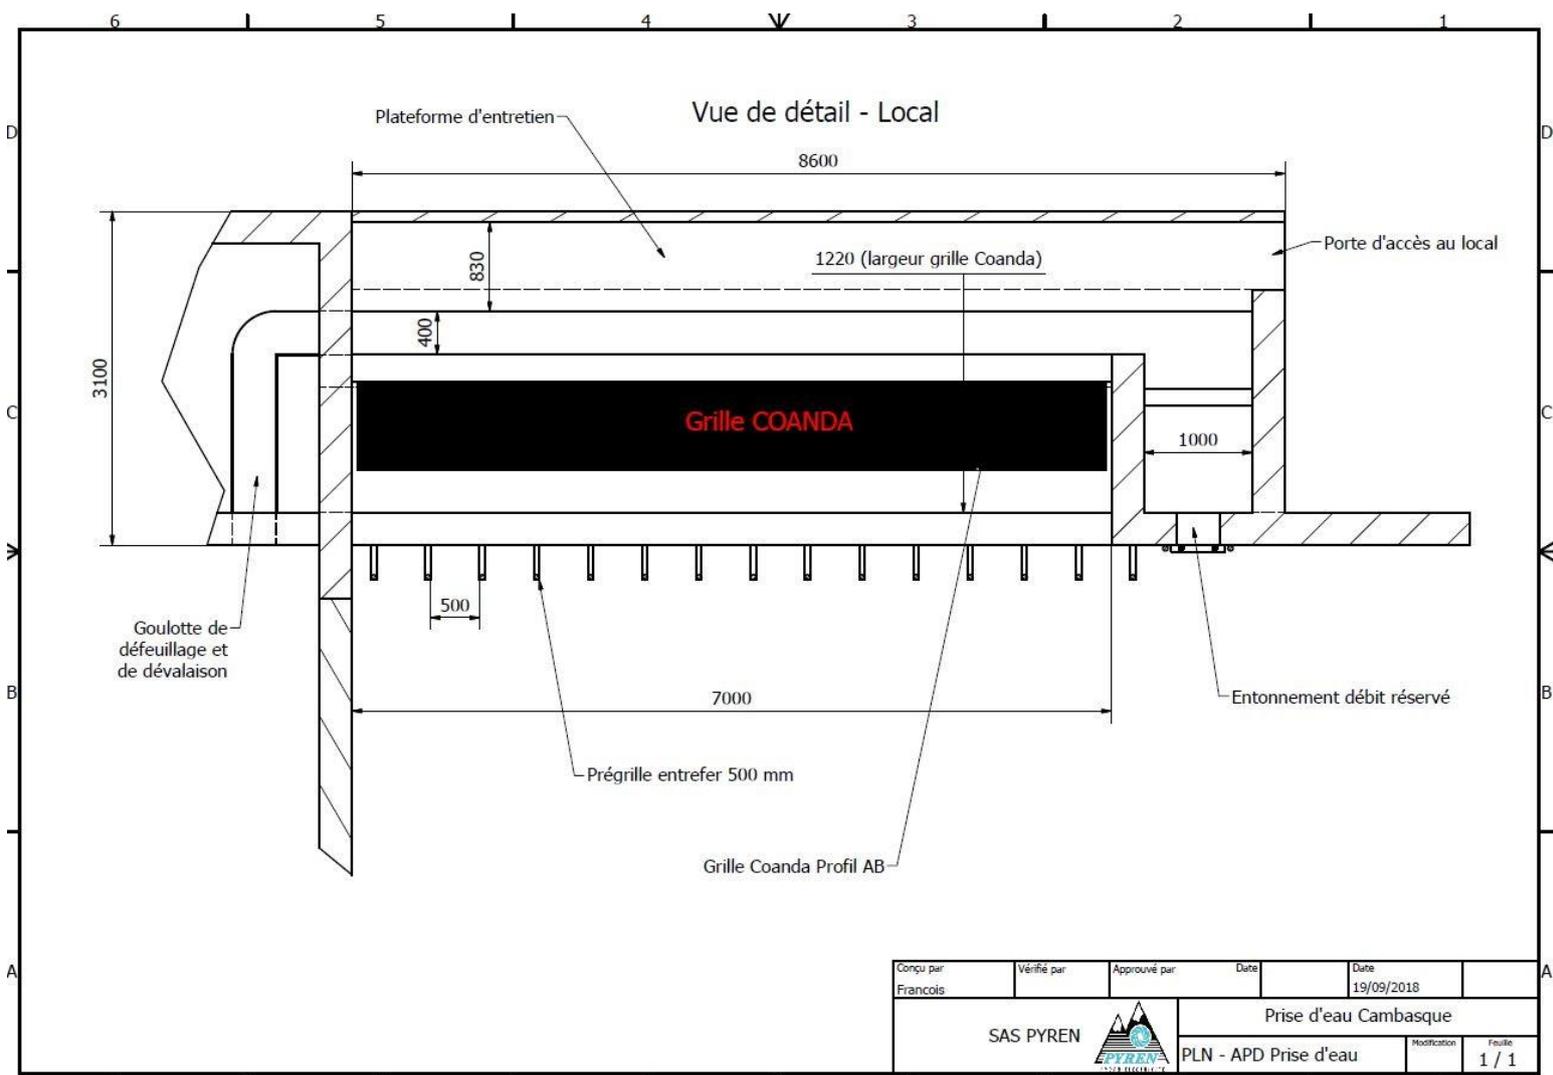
Vu en plan détails des installations de prise d'eau amont vanne rivière (source : PYREN)
